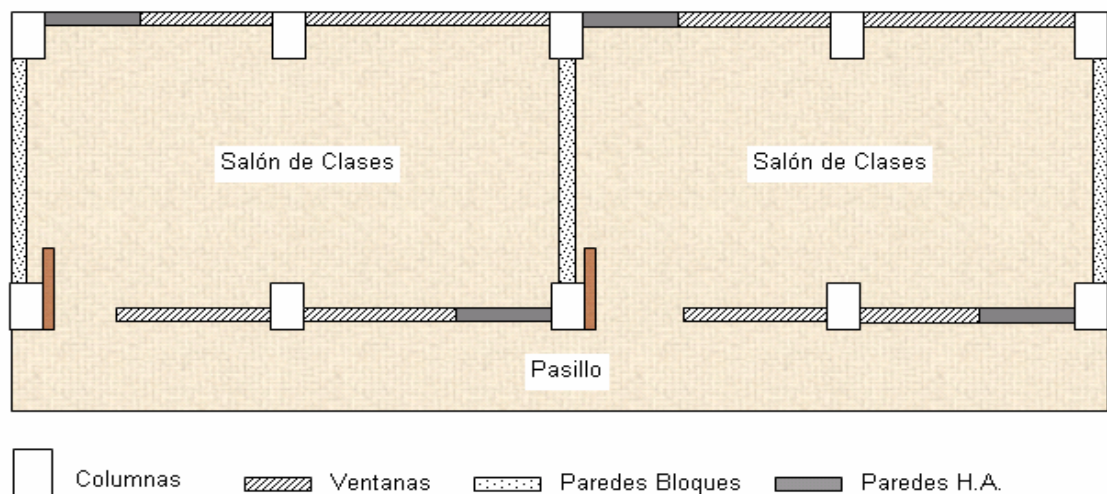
Planta típica de una escuela en Puerto Rico.
